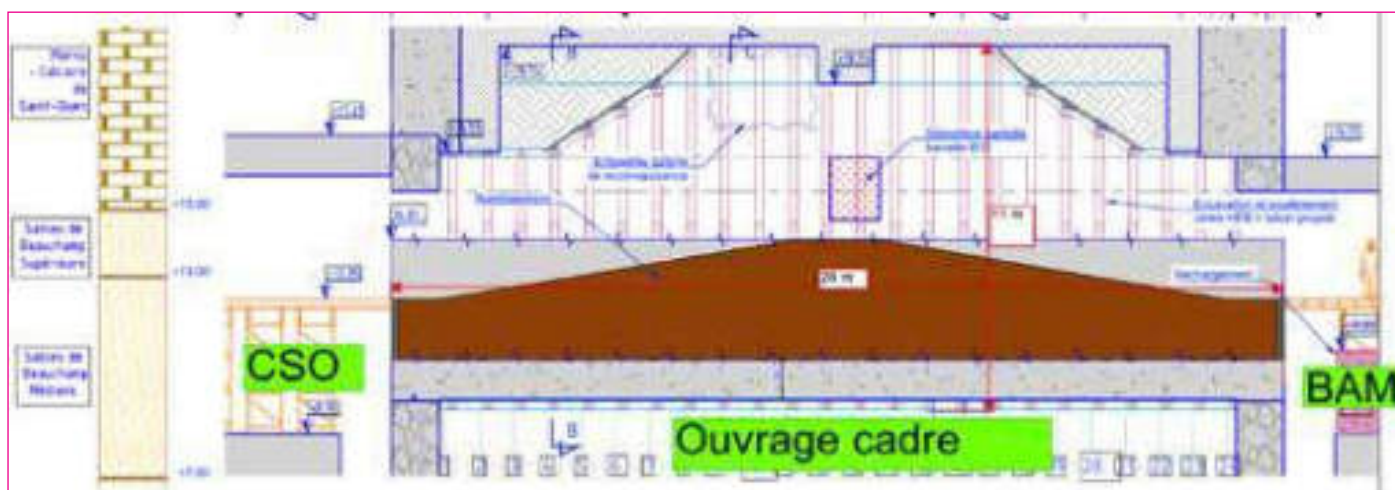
Coupe longitudinale de l'ouvrage cadre sous RER C - *Longitudinal section of the framework structure under RER C
